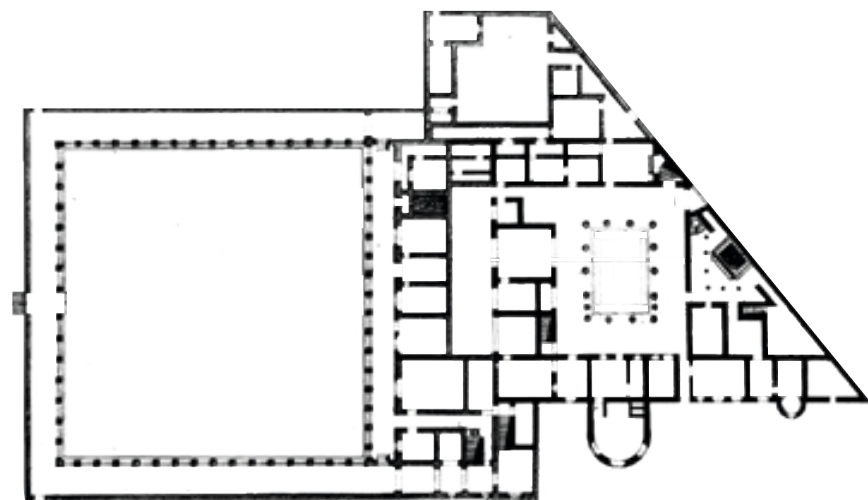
Grundriss Villa Di Diomede in Pompeji
